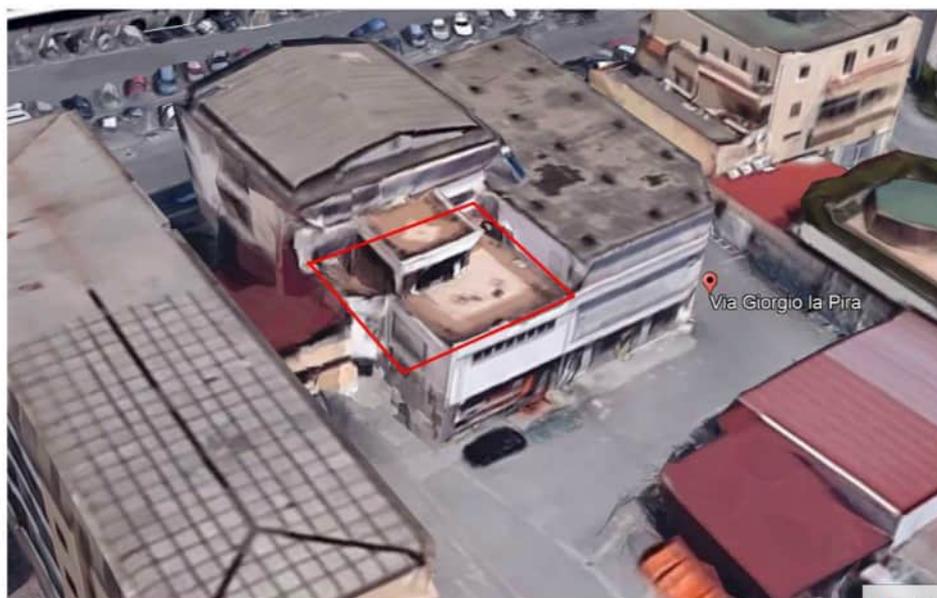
fabbricato non facente parte del progetto relativo alla concessione in sanatoria
